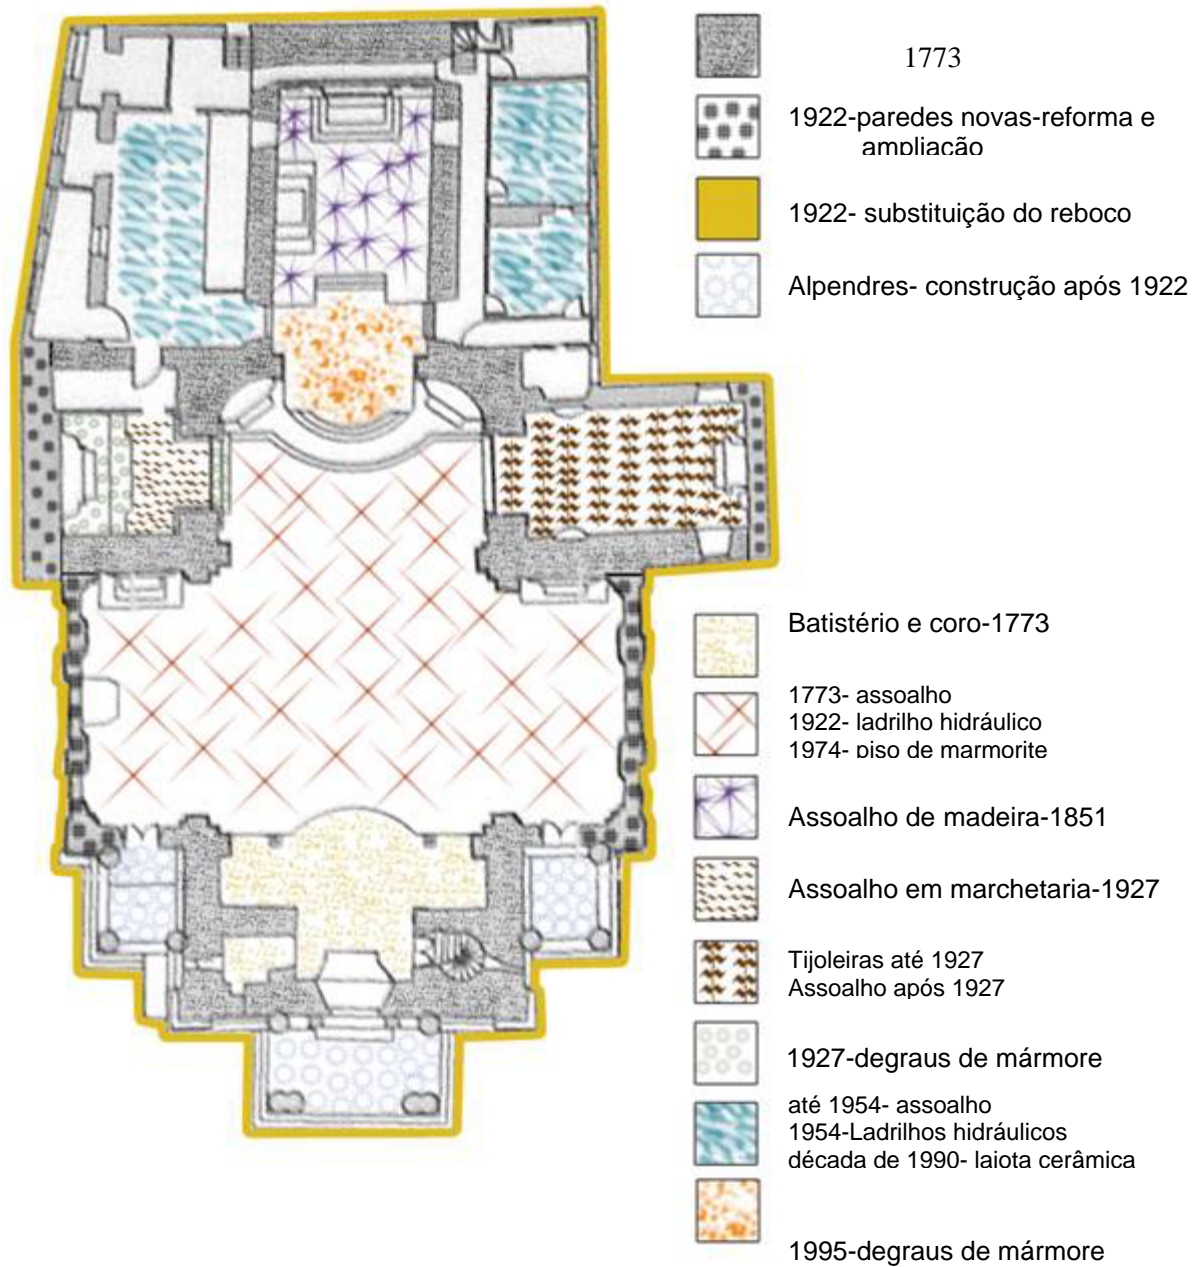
Leitura cronológica dos pisos e das estruturas parietais
